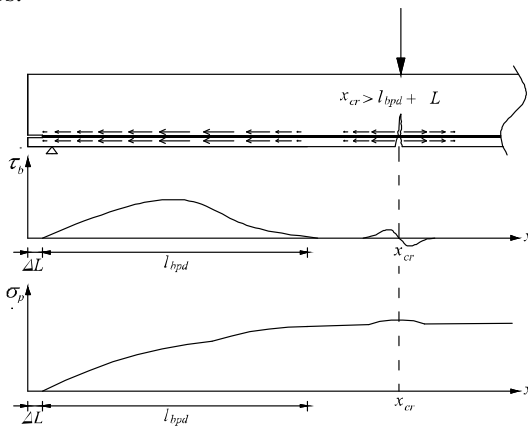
Equilíbrio de tensões na fissuração
